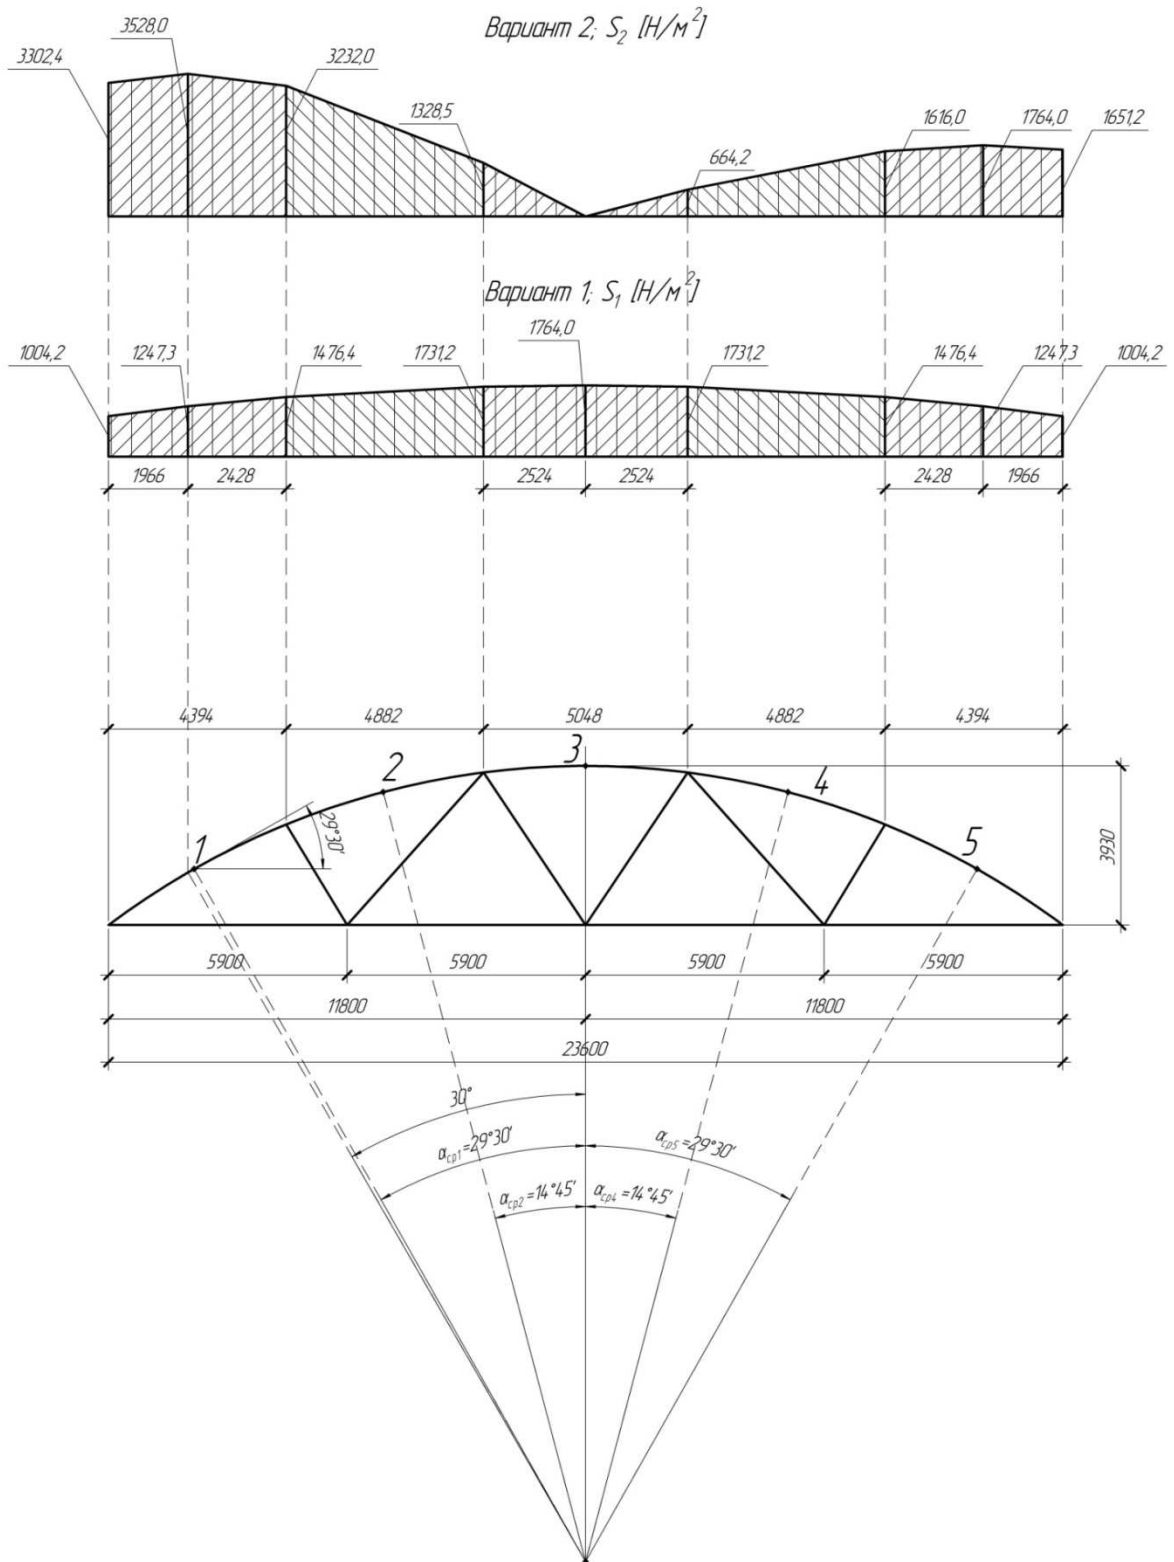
Схемы распределения снеговой нагрузки на сегментную ферму
